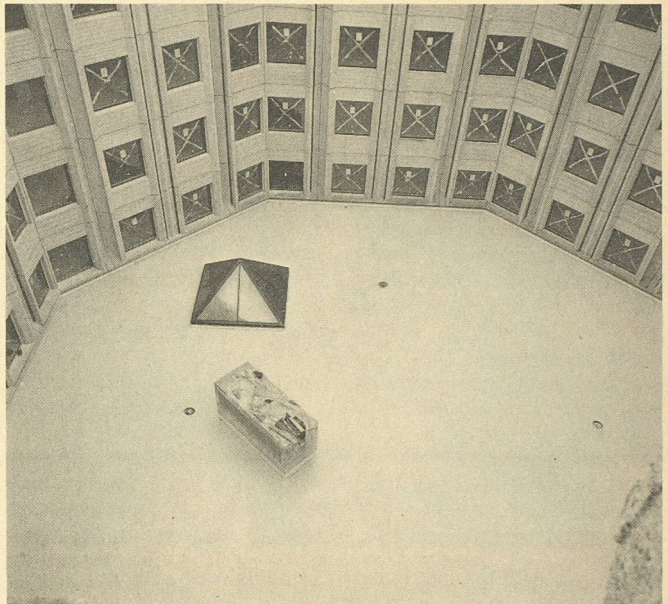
La dalle de béton est prête : les travaux d'étanchéité peuvent commencer.
